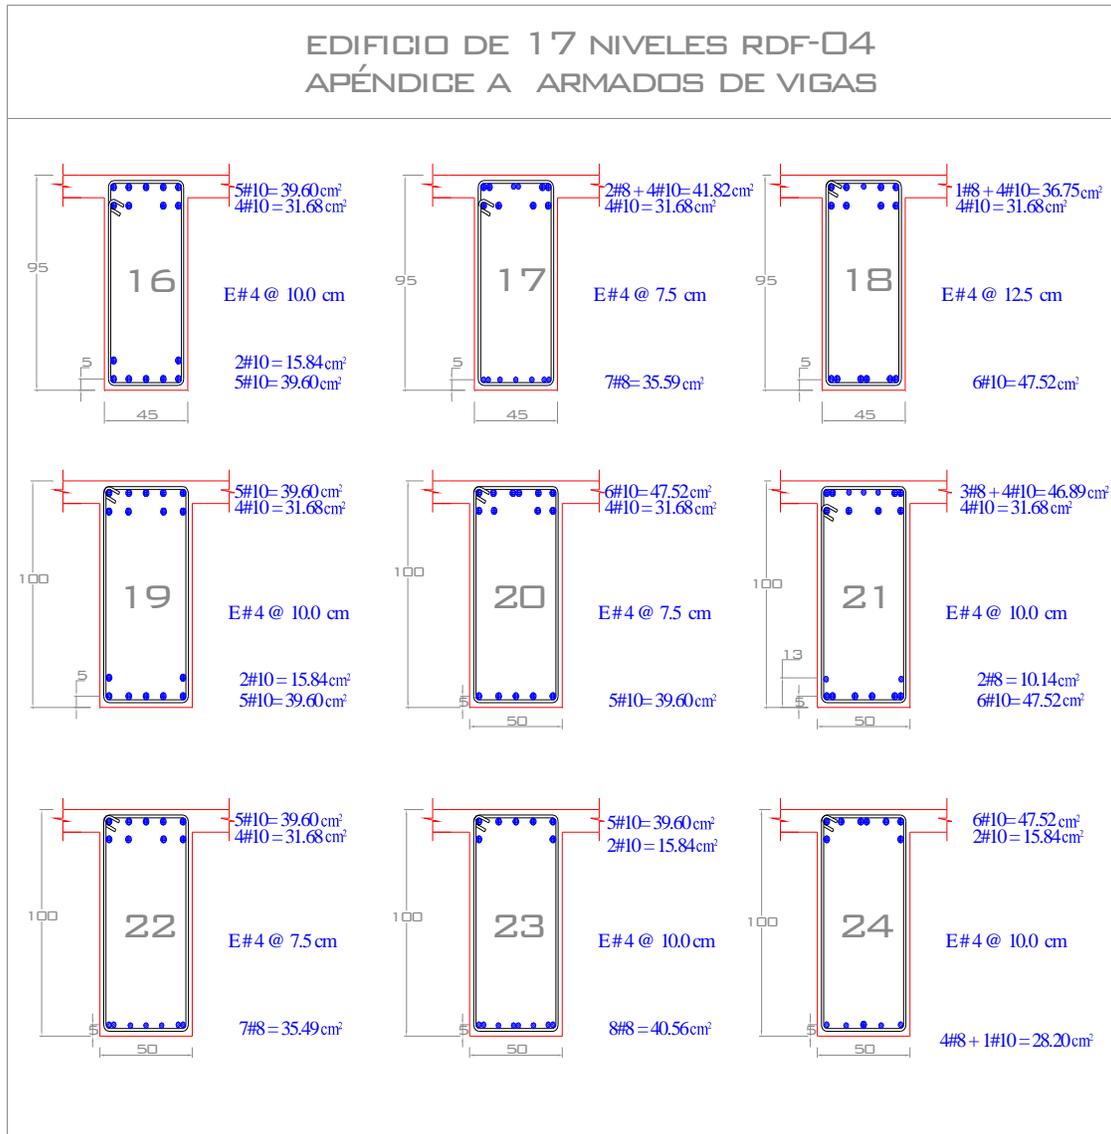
Armados longitudinal y transversal propuestos de vigas, edificio 17 niveles, Apéndice A (caso B) de las NTC-Sismo, RDF-04
